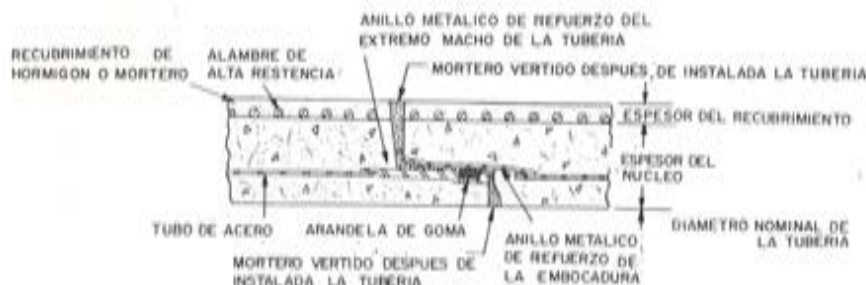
Sección-tipo de una tubería cilíndrica, de hormigón pretensado, con camisa metálica intermedia.
